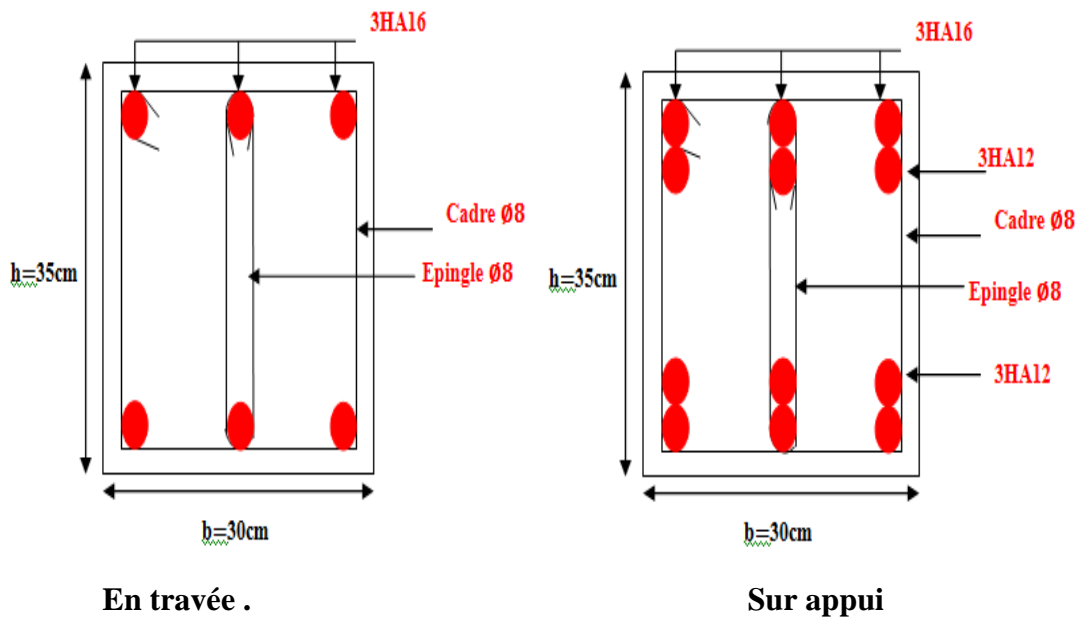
Ferraillage des poutres secondaires étage courant 30×35.
